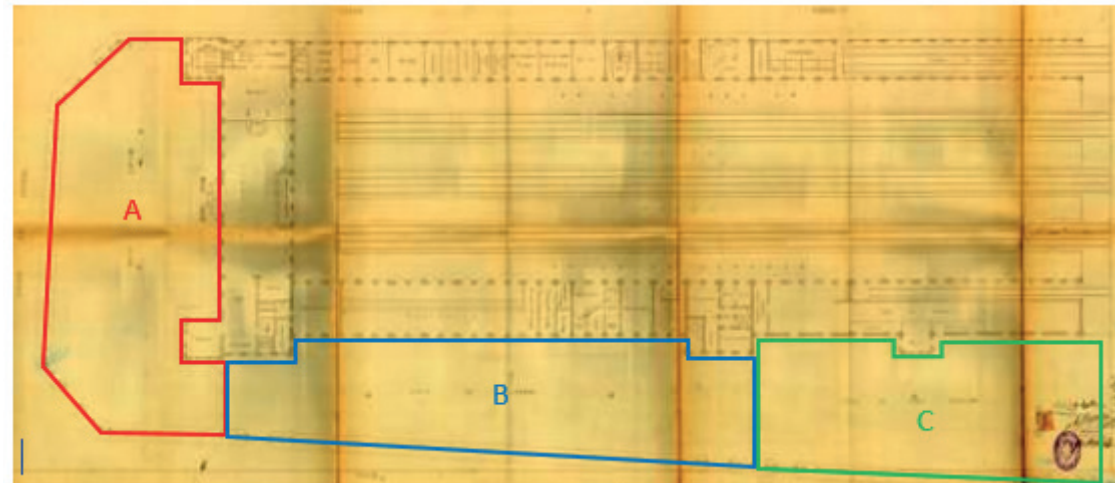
Esquema de distribución de patios exteriores - Planta baja original (1907)
